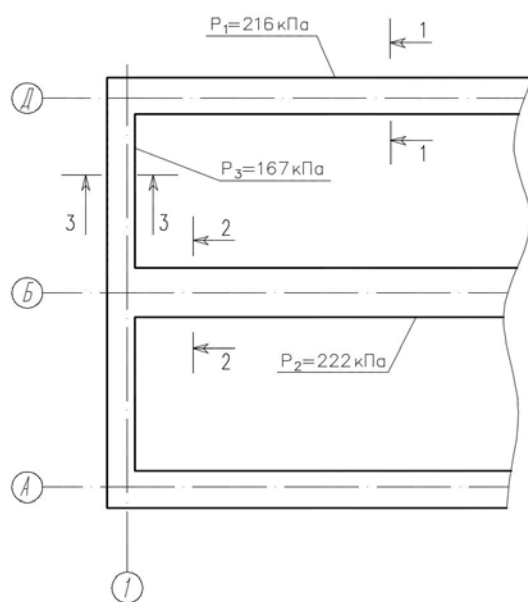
Фрагмент плана фундаментов дома 111 по ул. Новоселов с выделенными расчетными сечениями
